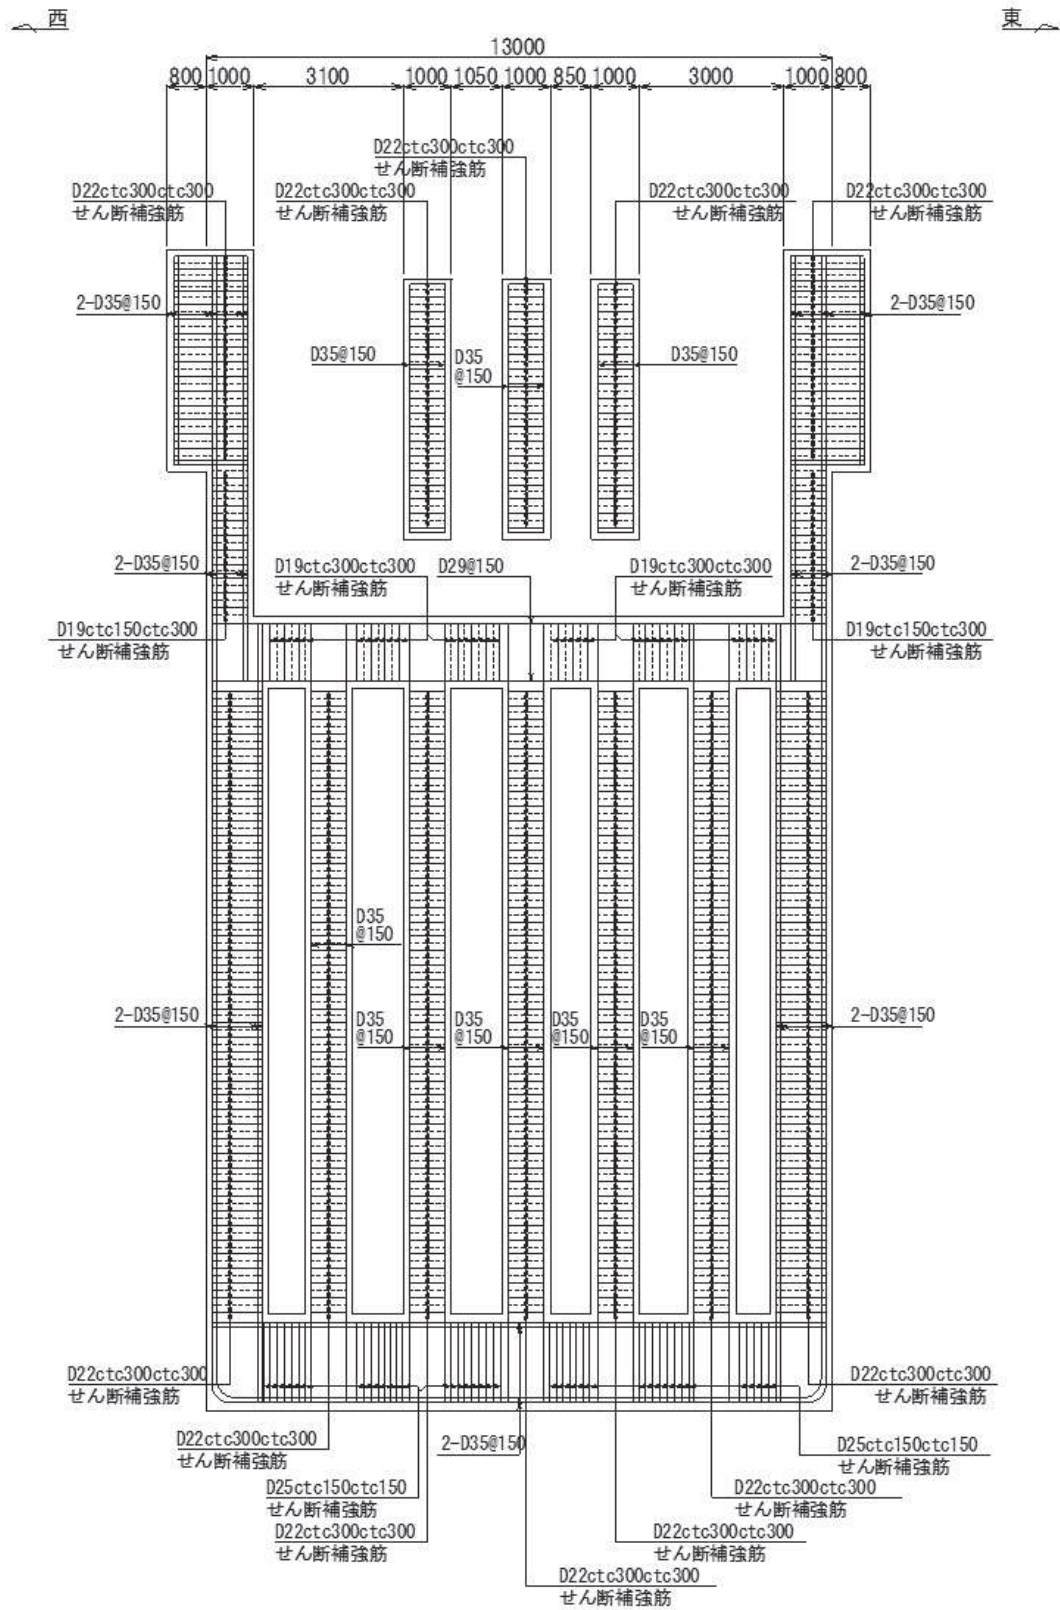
第 3 号機補機冷却海水系放水ピット概略配筋図 (平面図)
